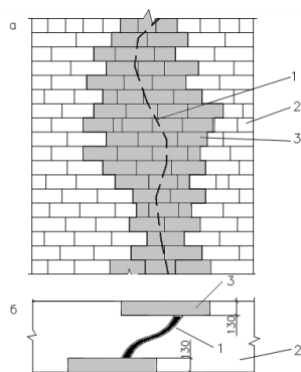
Восстановление каменной кладки частичной перекладкой:
